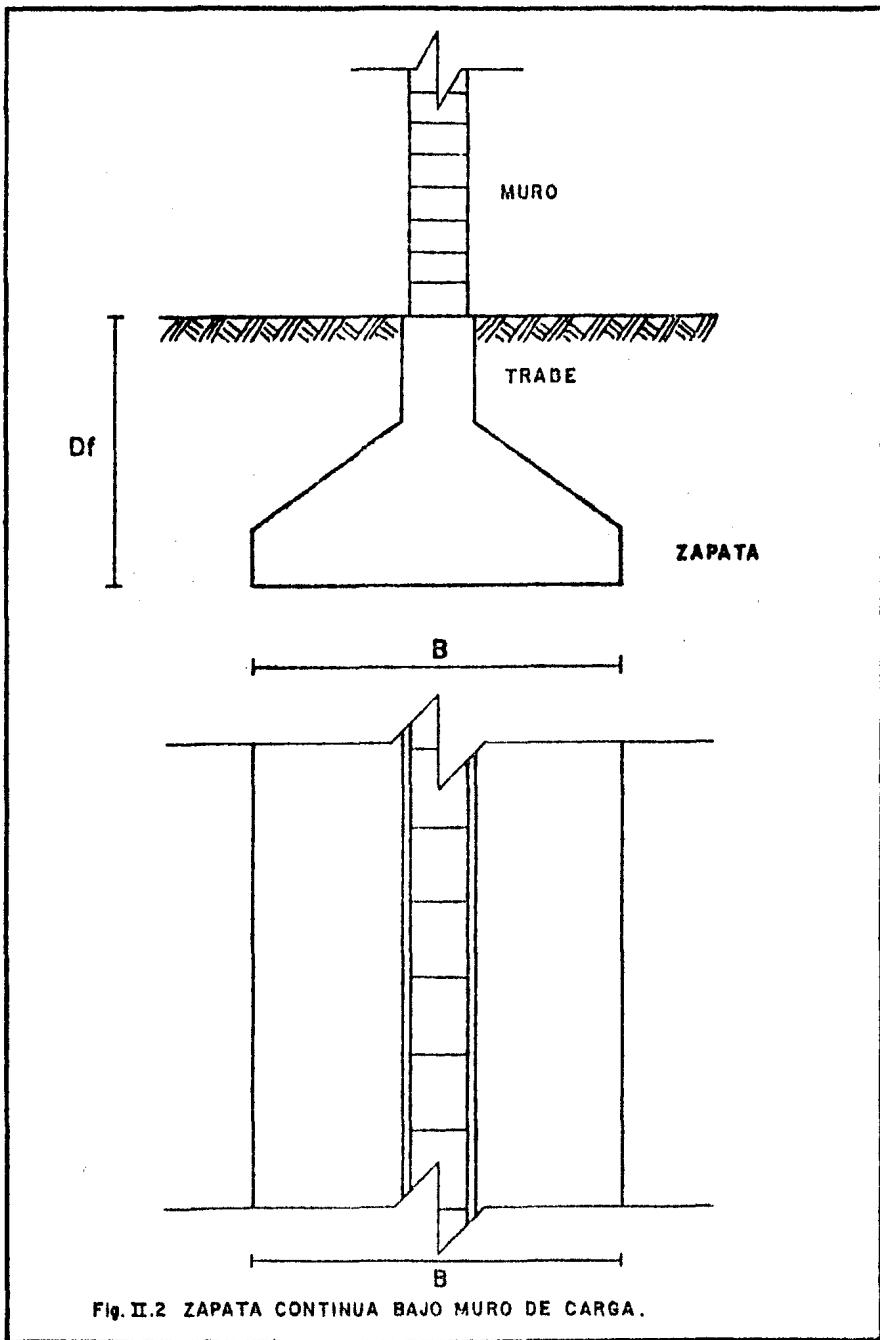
ZAPATA CONTINUA BAJO MURO DE CARGA.
